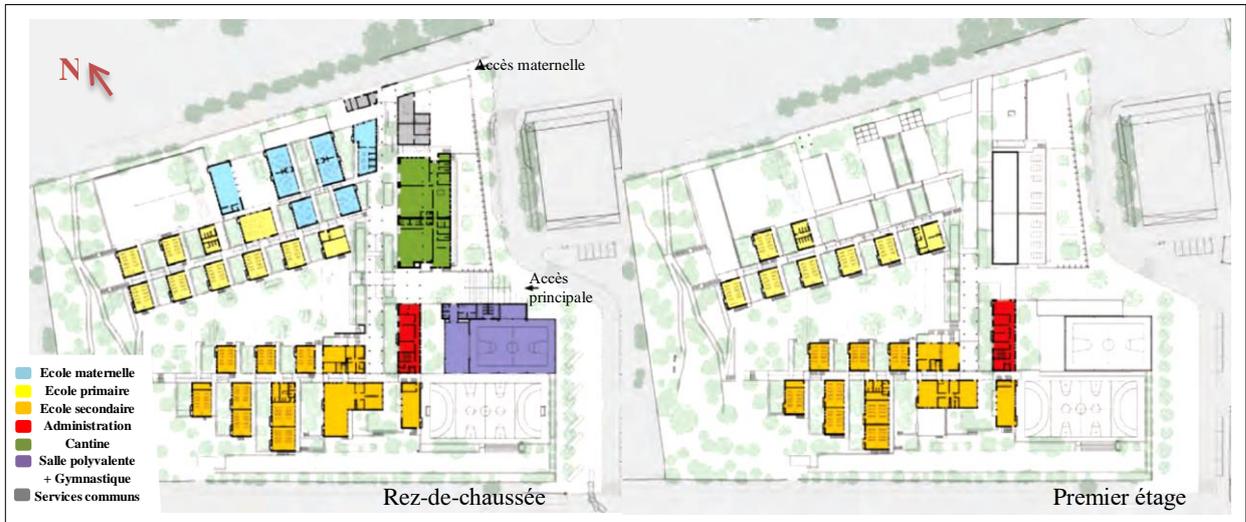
Vue en plan du rez-de-chaussée et 1^{er} étage du lycée.
